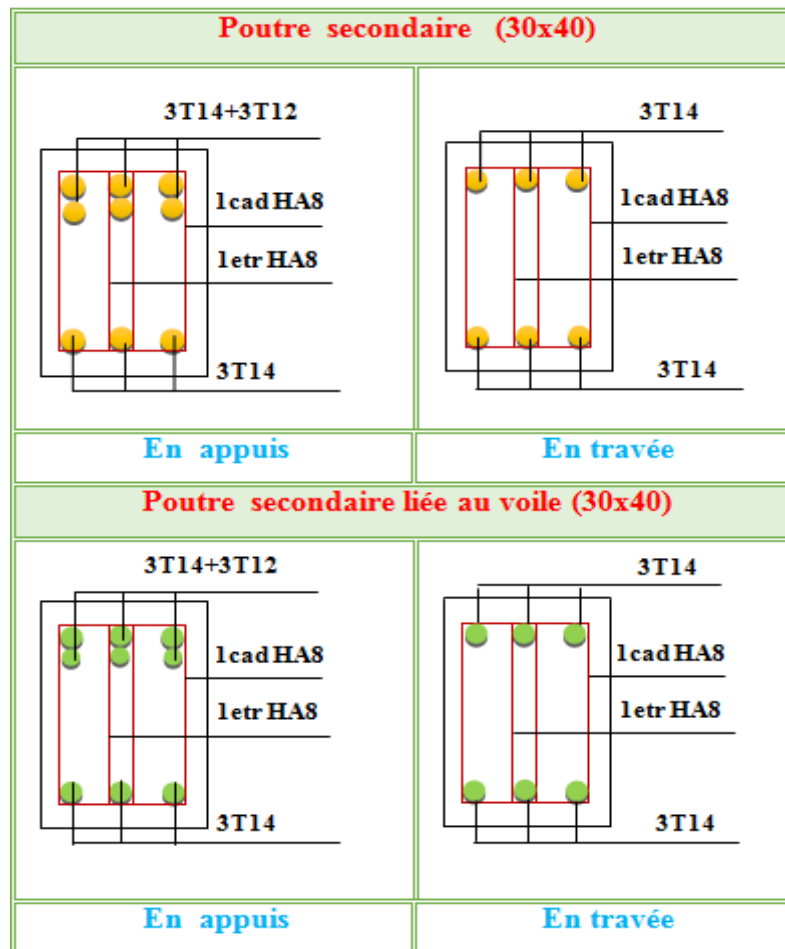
Schéma de ferrailage des poutres secondaire.
